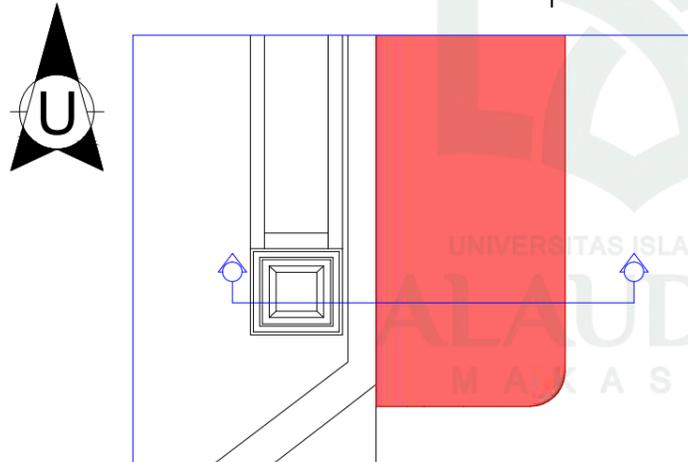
DETAIL PEDESTRIAN BAGIAN DALAM TAPAK
